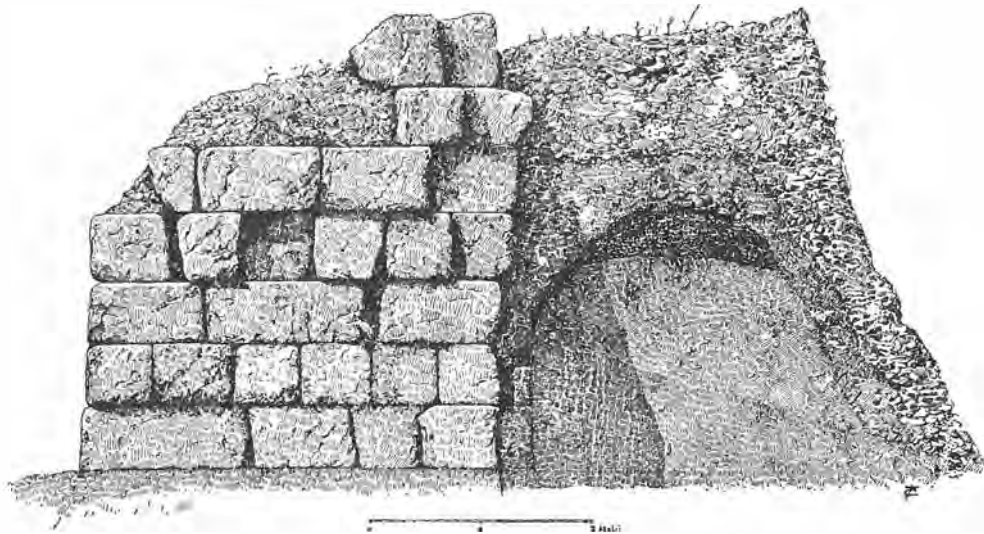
QUIR. G. Sezione del terrapieno; prospetto dell'estremità sud del muraglione. (Notizie 1910, 511, fig. 13.)
